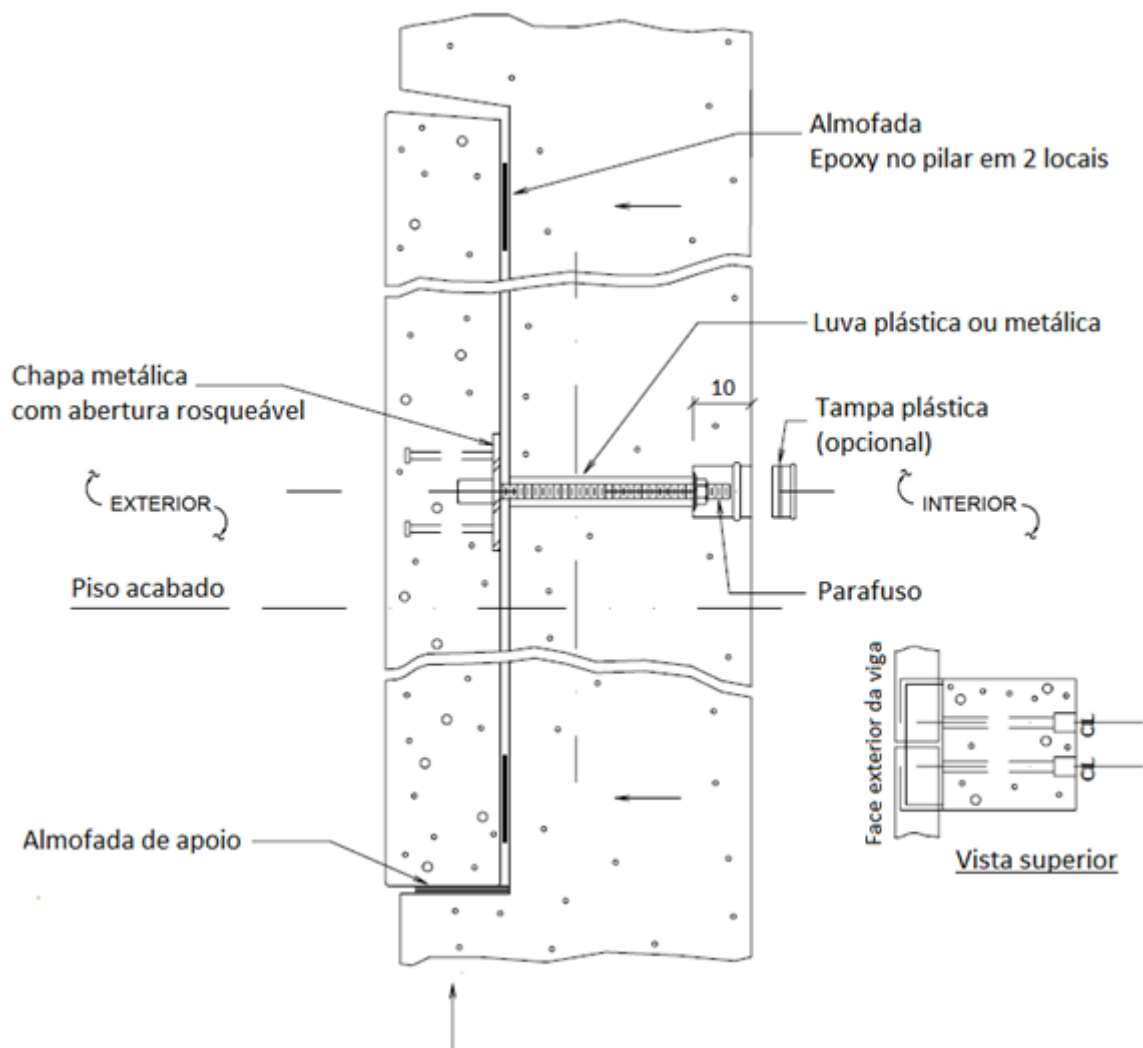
Detalhe da ligação típica entre vigas delgadas de seção “L” e pilares em estruturas de CPM [PCI, 1998].
